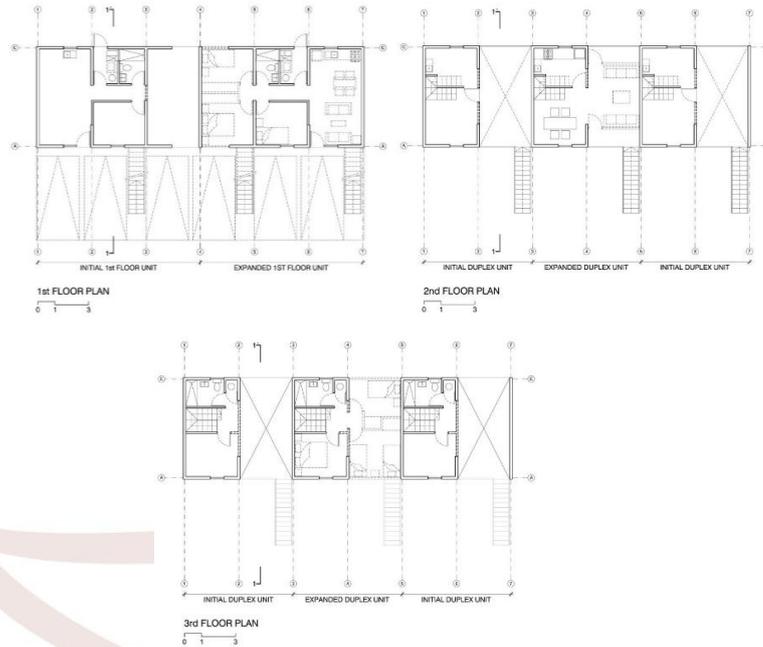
Plantas dos Pavimentos Térreo, Segundo e Terceiro Andar
